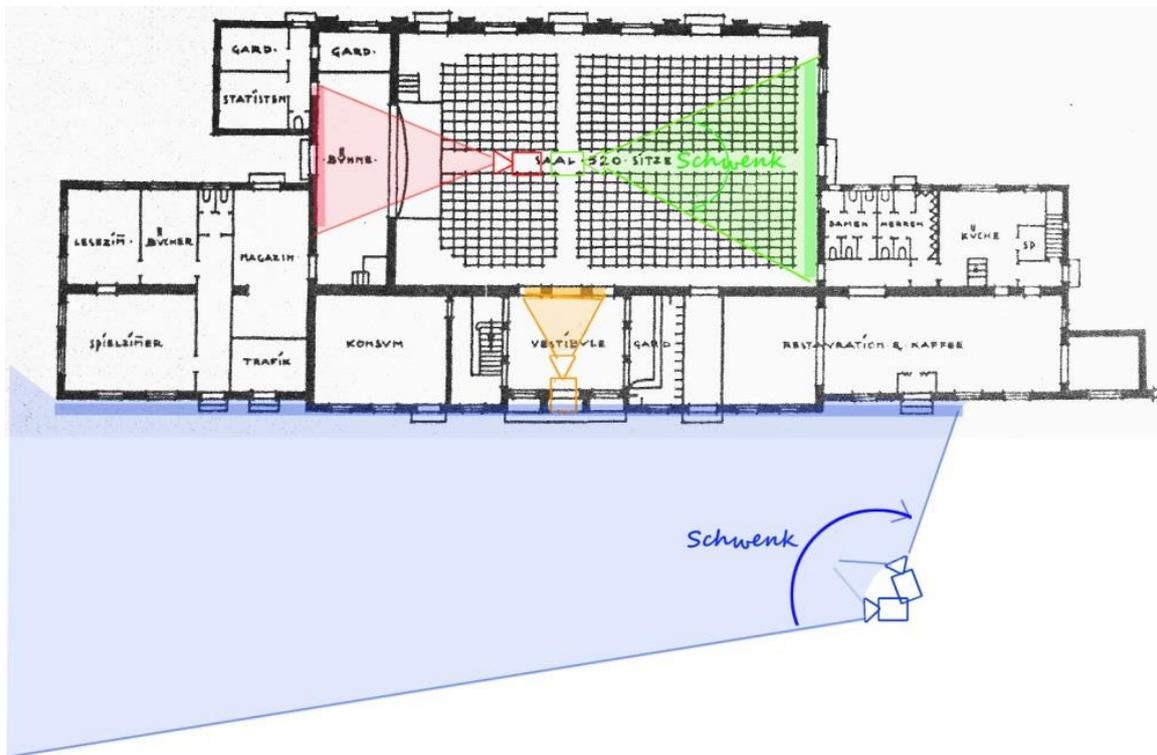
Grundriss des Genossenschaftshauses der Siedlung Rosenhügel mit den Blickrichtungen der Kamera
